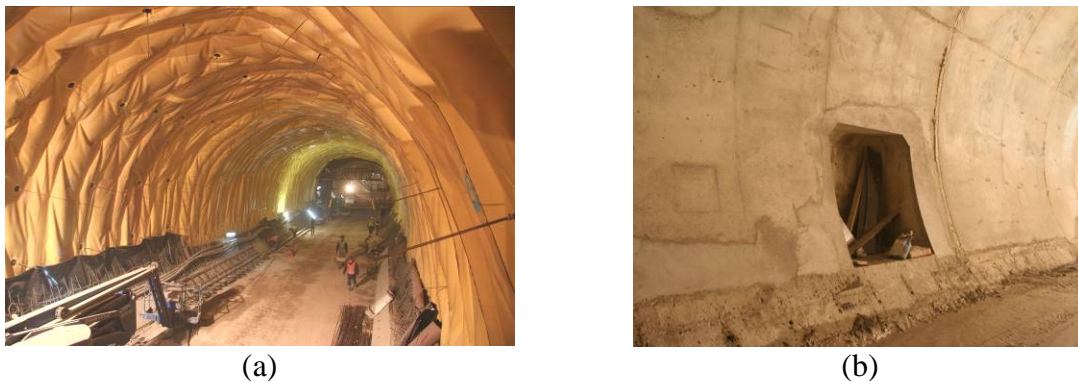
Acabamento final do túnel: (a) colocação da impermeabilização do interior do túnel; (b) aspecto da nova secção de betão armado
